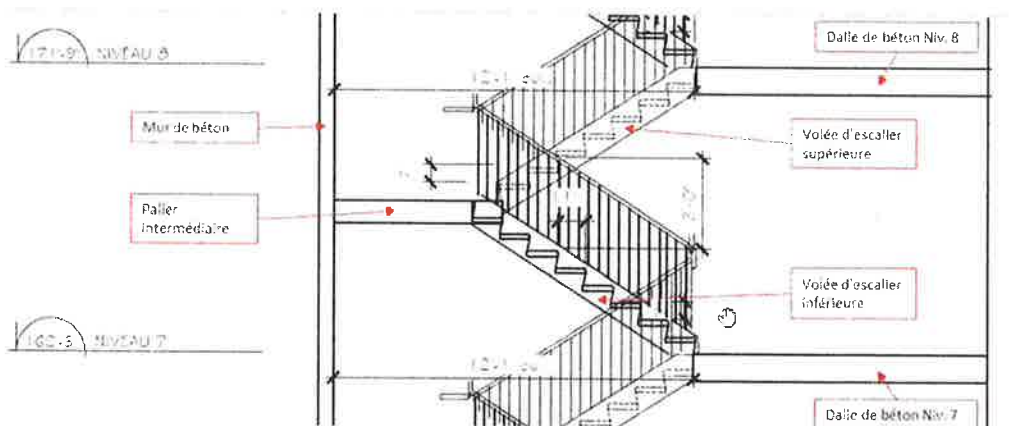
Coupe type de l'escalier n° 1 entre les niveaux 7 et 8
